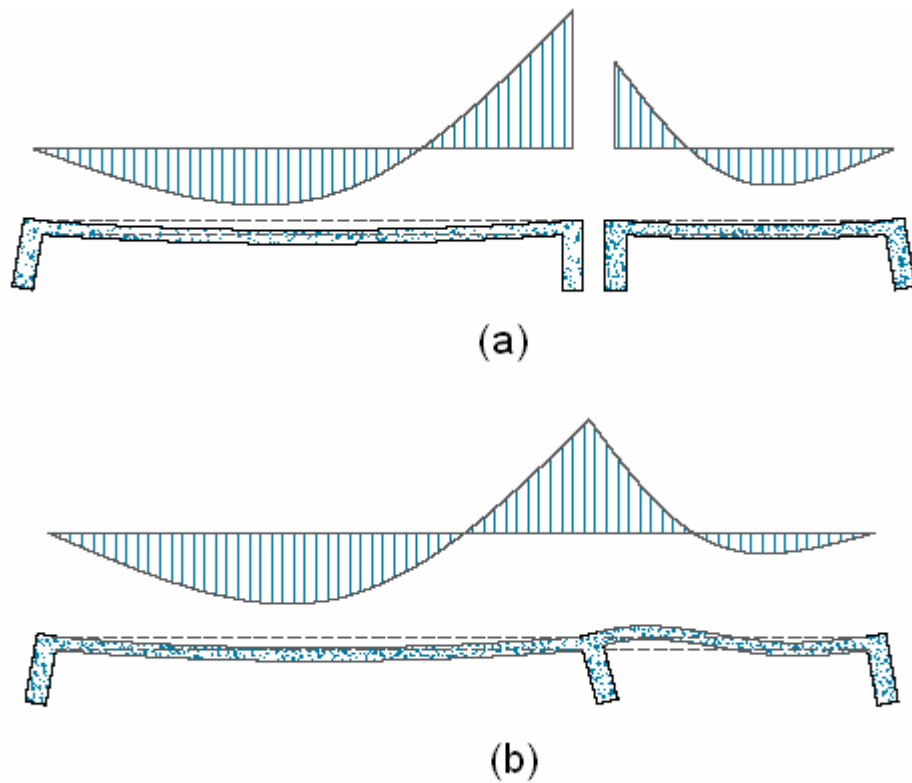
Lajes perfeitamente engastadas (a) e lajes compatibilizadas (b)
